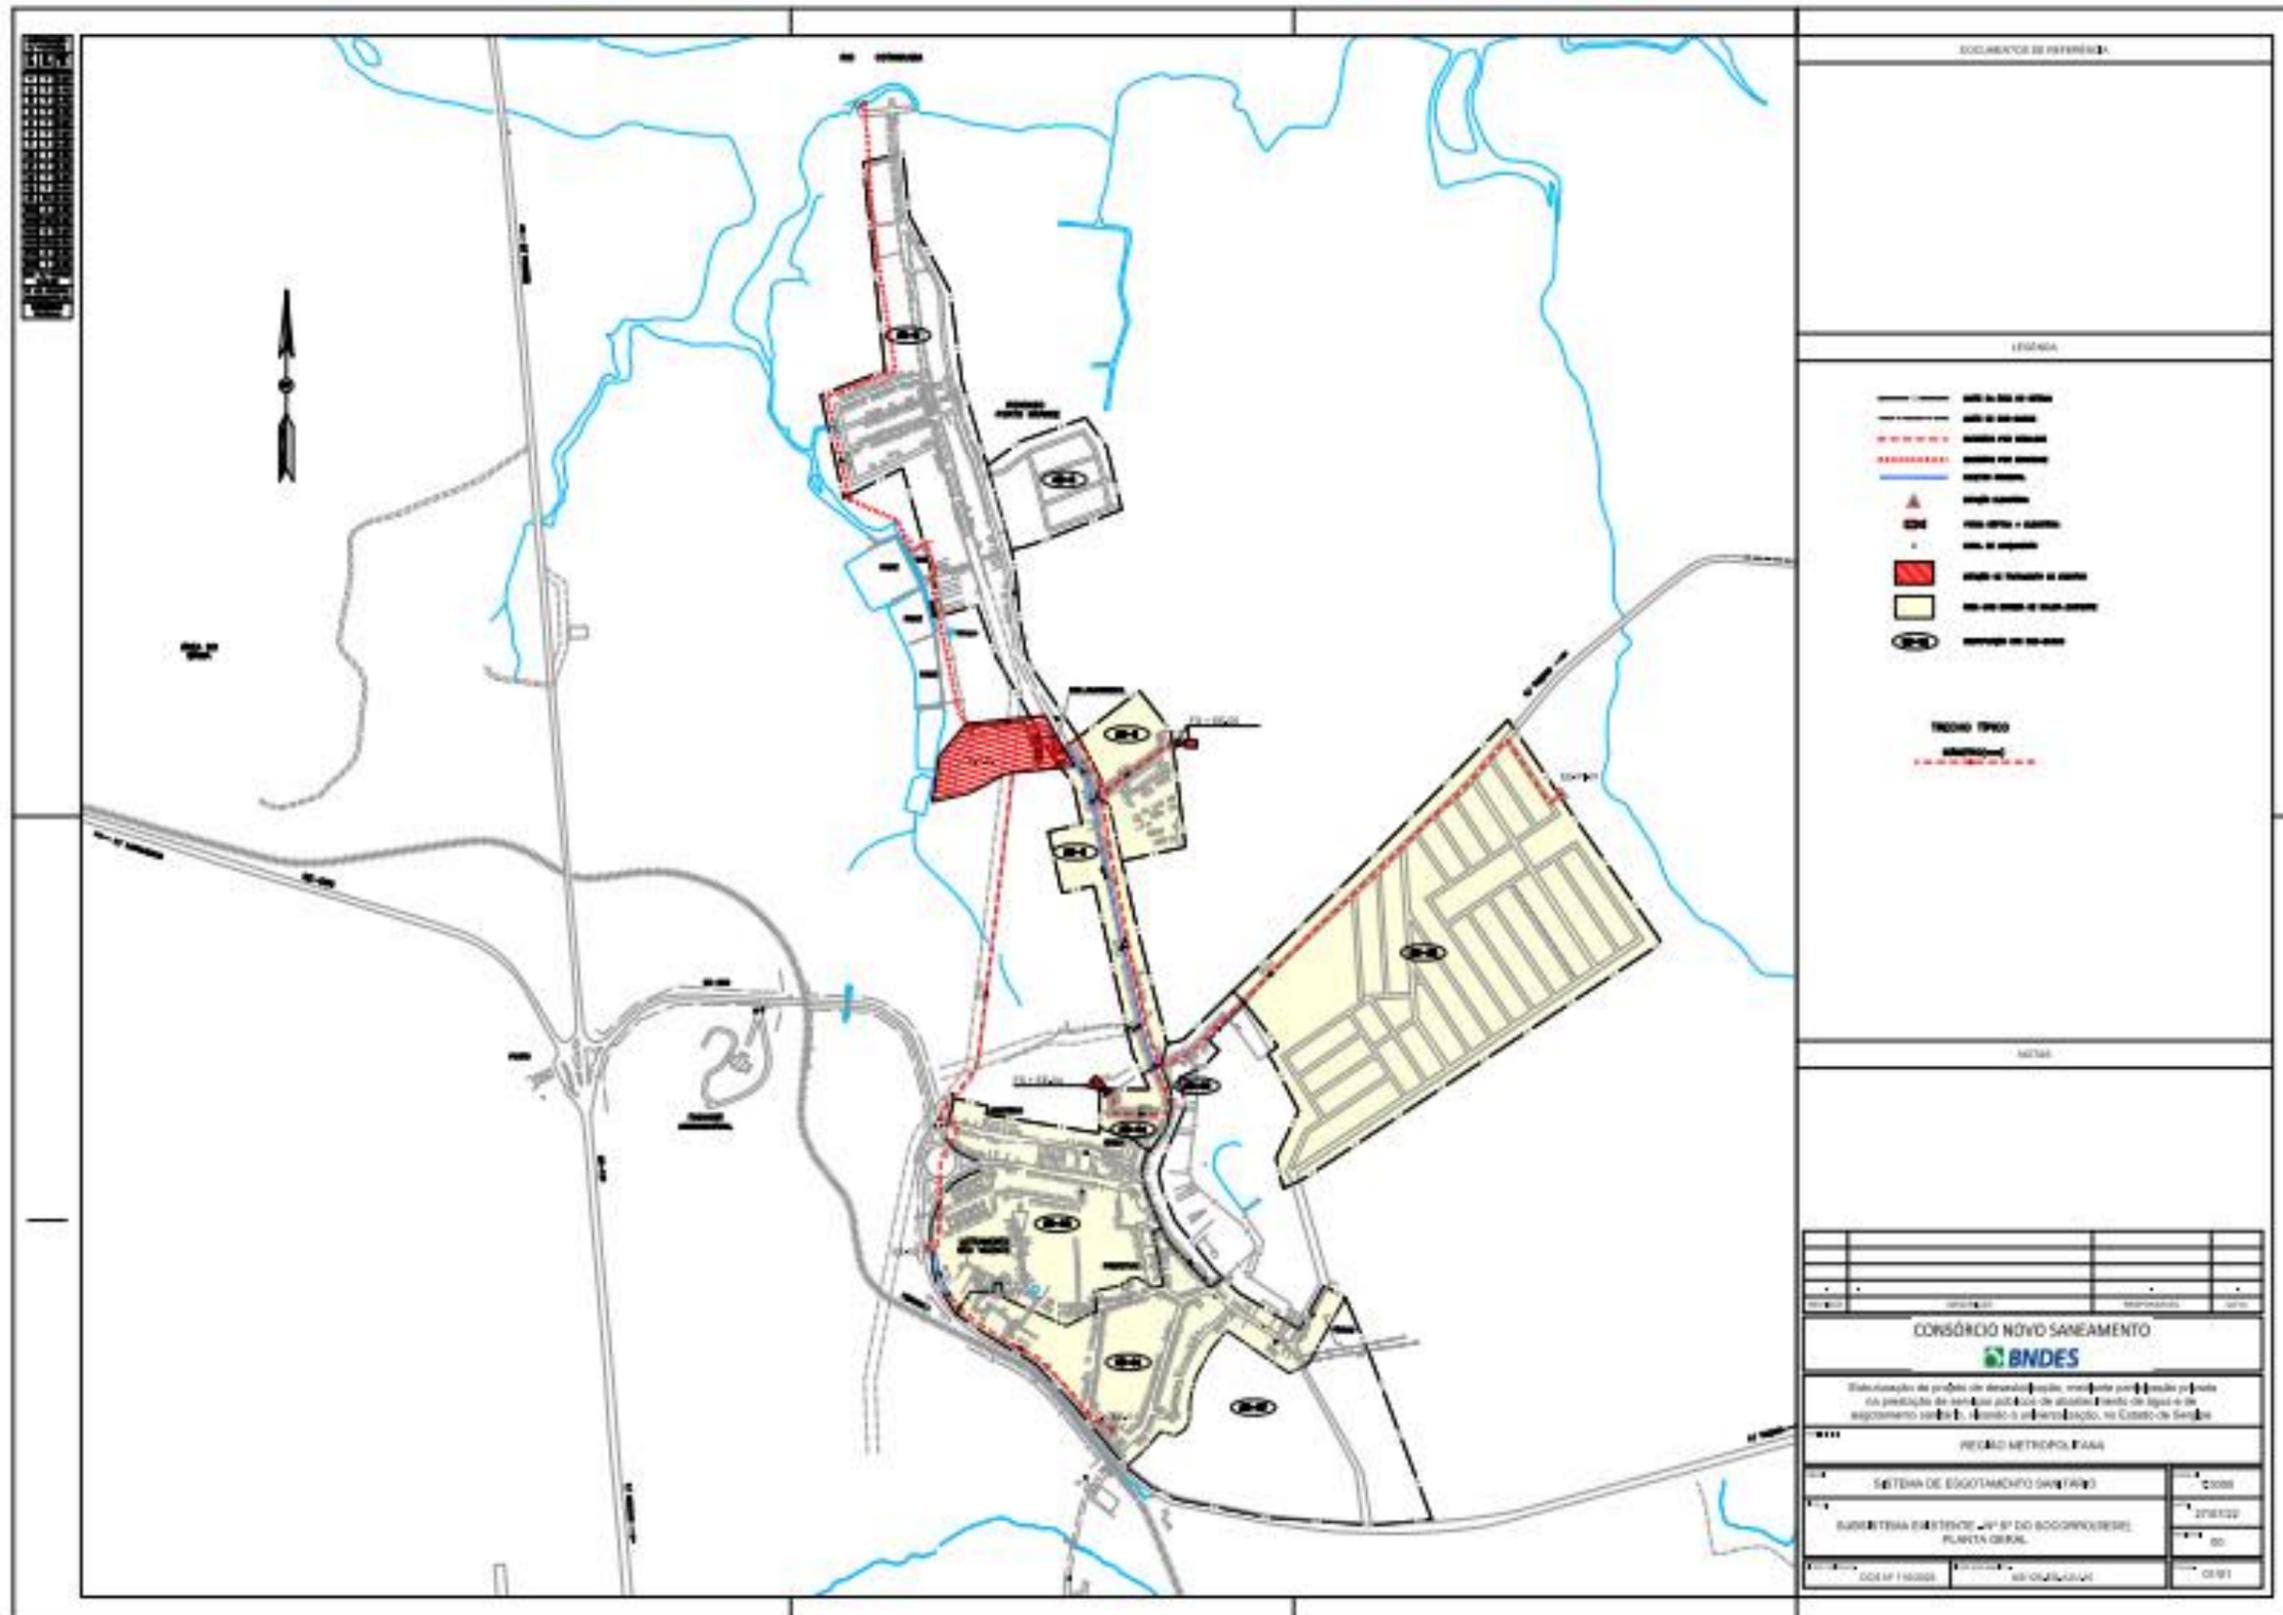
Planta do Sistema de Esgotamento Sanitário da Região Metropolitana – NOSSA SENHORA DO SOCORRO
